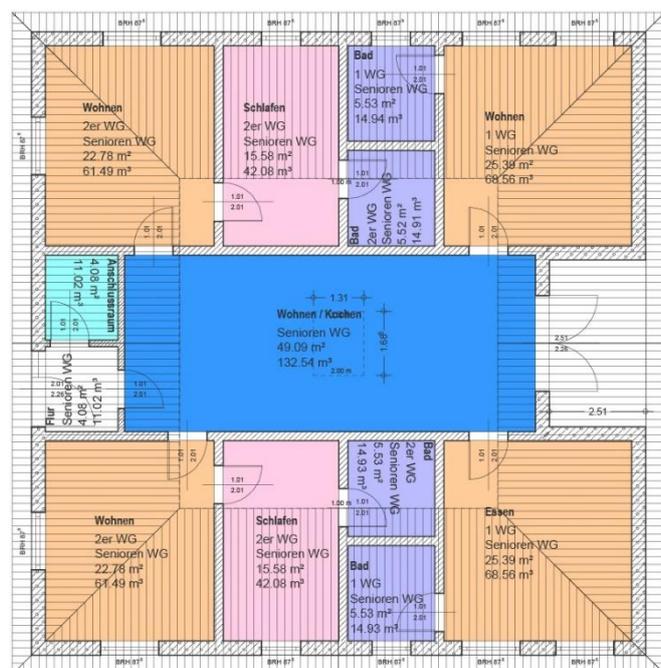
Grundriss Pavillon 2021, Architekt G.Pickhardt
